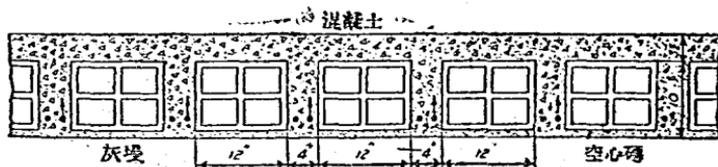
鋼筋混凝土及空心磚樓板的截面。
